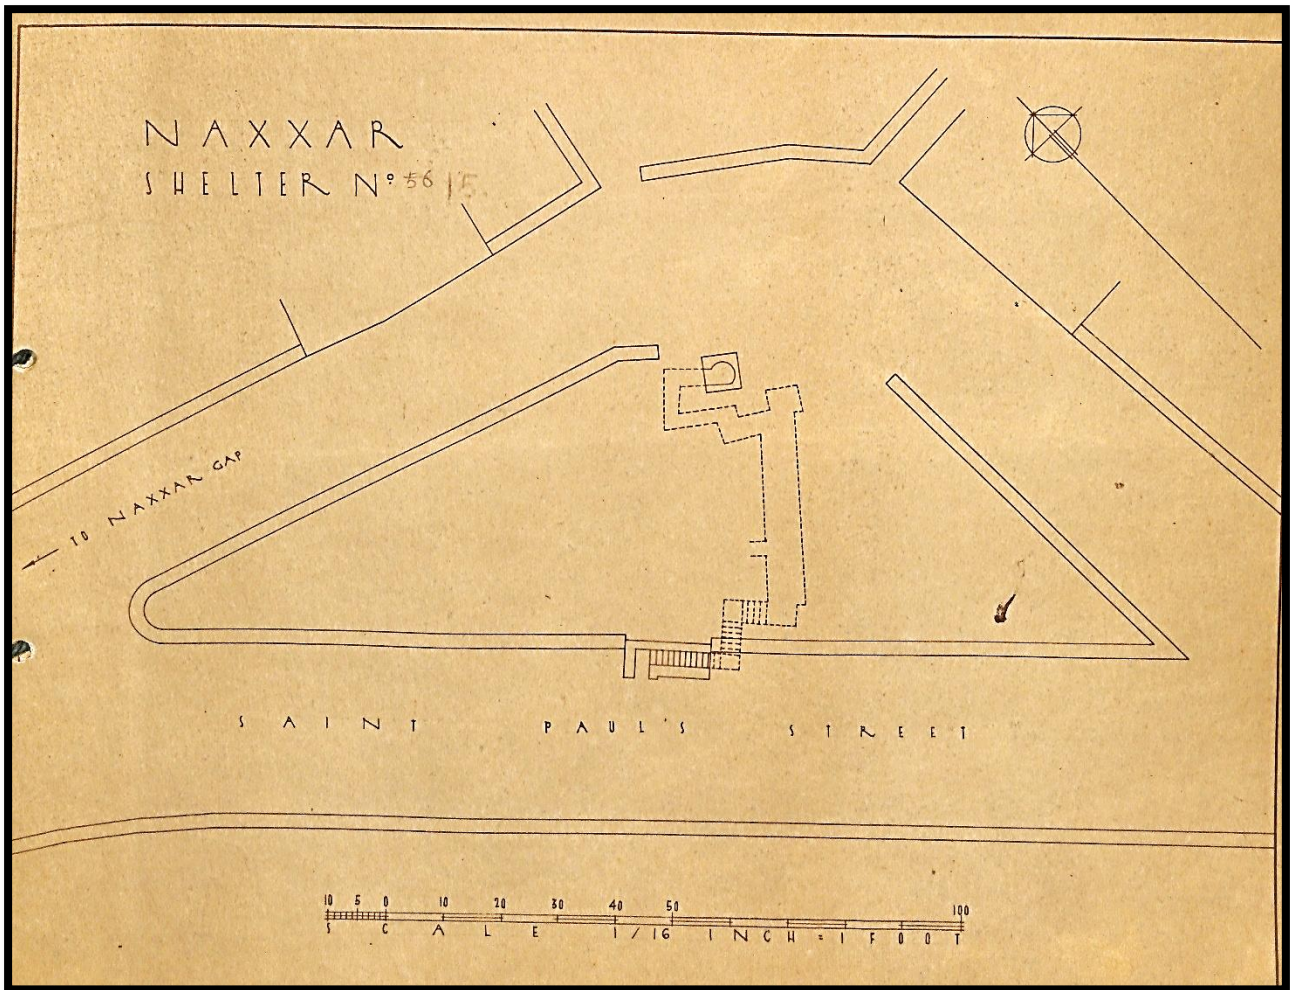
Planta do Abrigo nº56 (15) "Saint Paul's Street"
